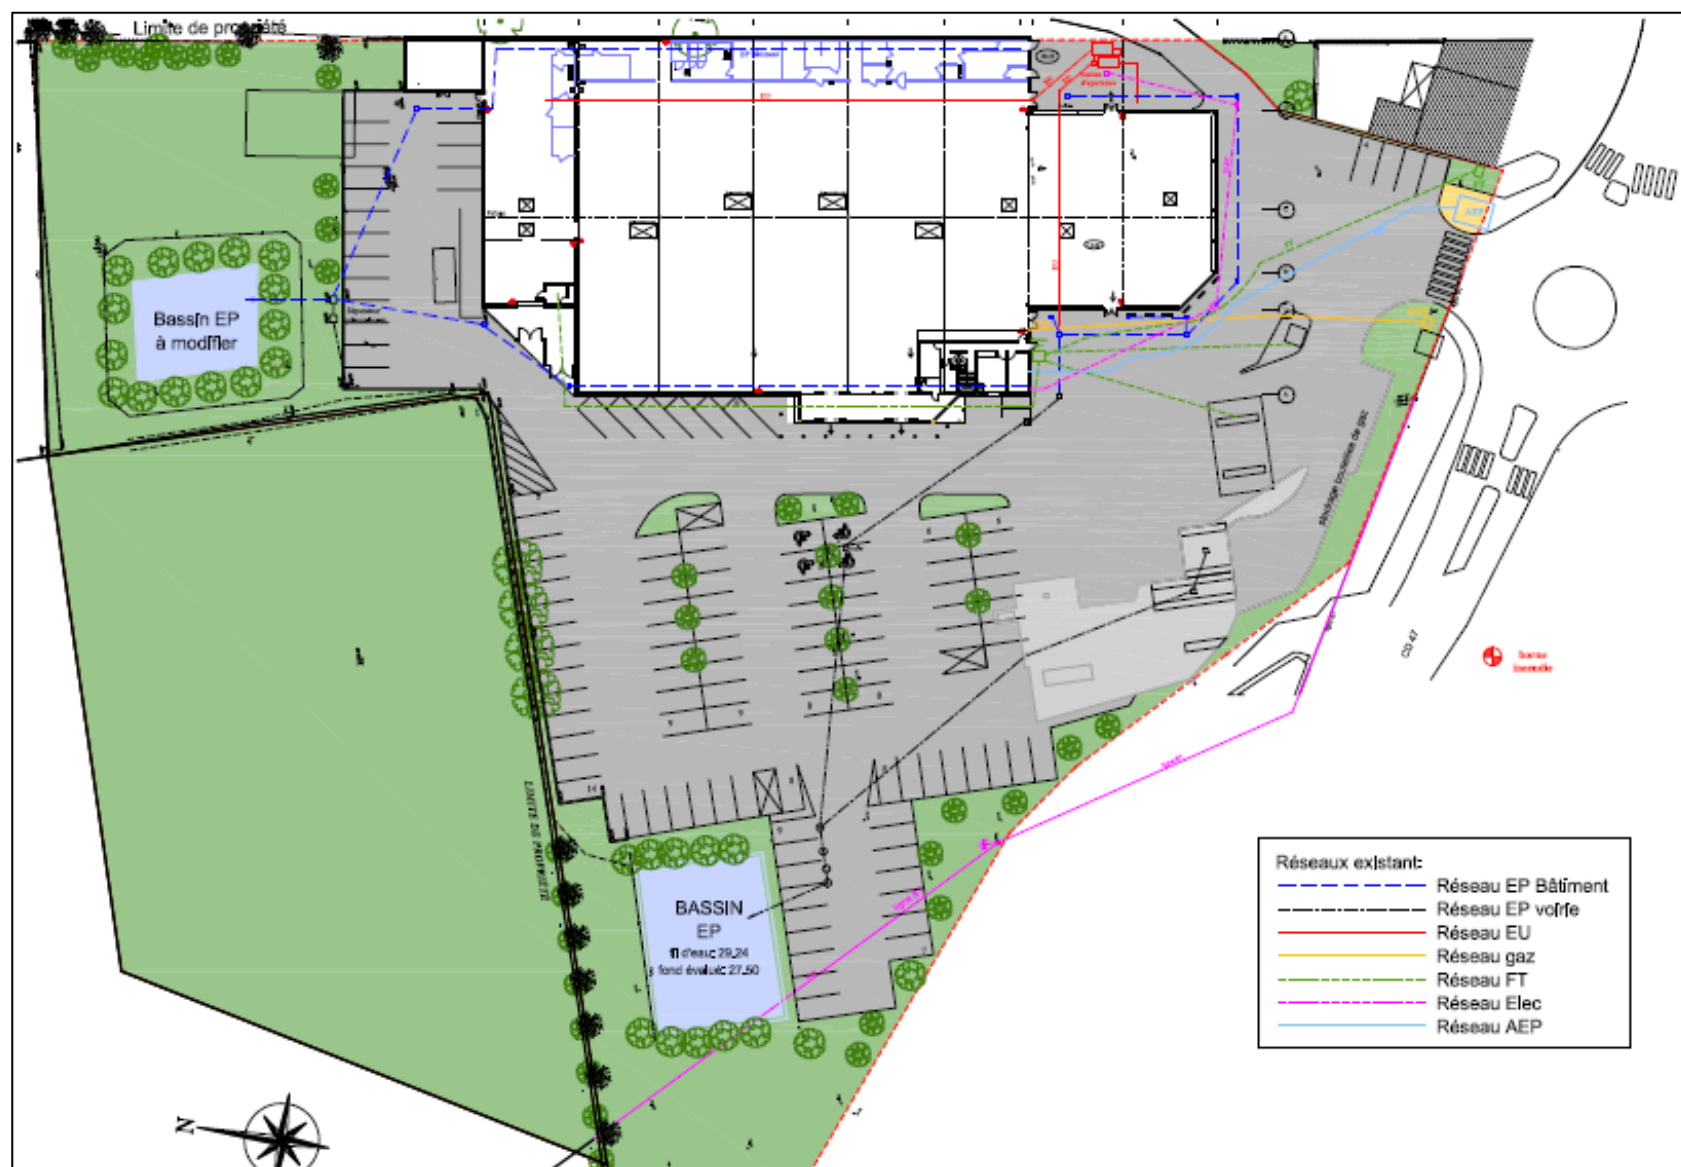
Plan de principe de collecte des eaux pluviales ; état initial
